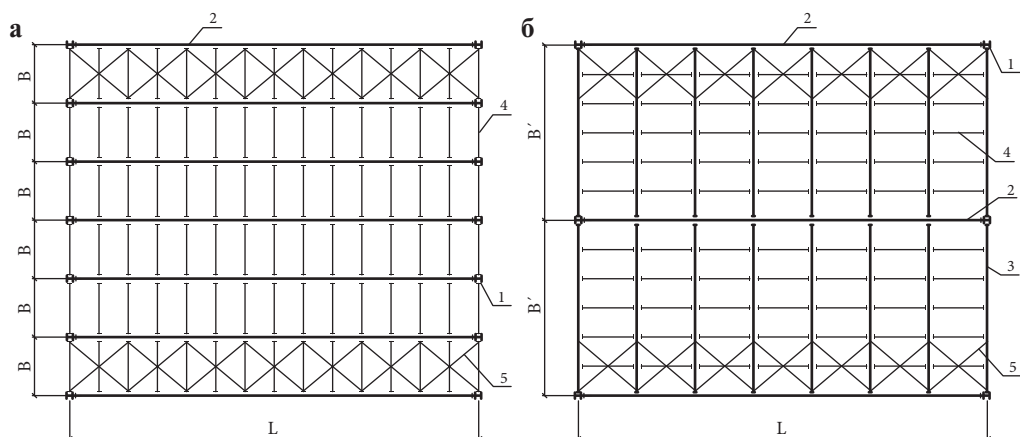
Компоновочные схемы несущих конструкций покрытия: а) нормального типа; б) усложненного типа; L — пролет здания; B и B' — шаг ферм в продольном направлении в нормальном типе; B' — шаг ферм в продольном направлении в усложненном типе; 1) колонны; 2) главная поперечная ферма; 3) продольные промежуточные фермы; 4) прогоны; 5) система связей
